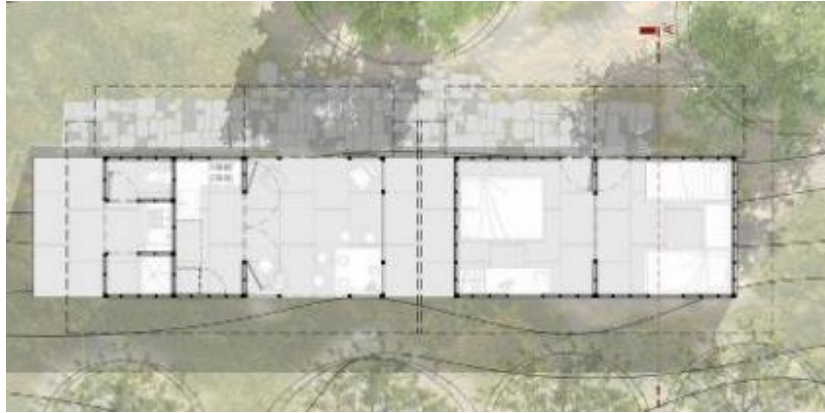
Plantas, Sistema arquitectónico para la vivienda rural, ensamble de arquitectura integral, Fundación, Magdalena, Colombia.
